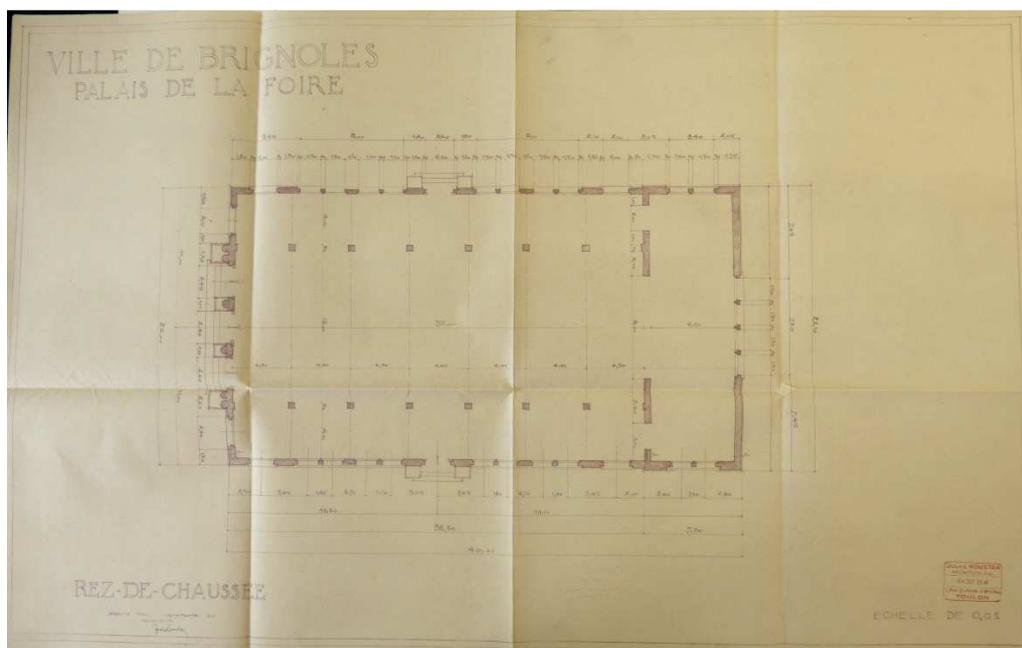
Roustan Jules, Palais de la Foire. Plan du rez-de-chaussée.
